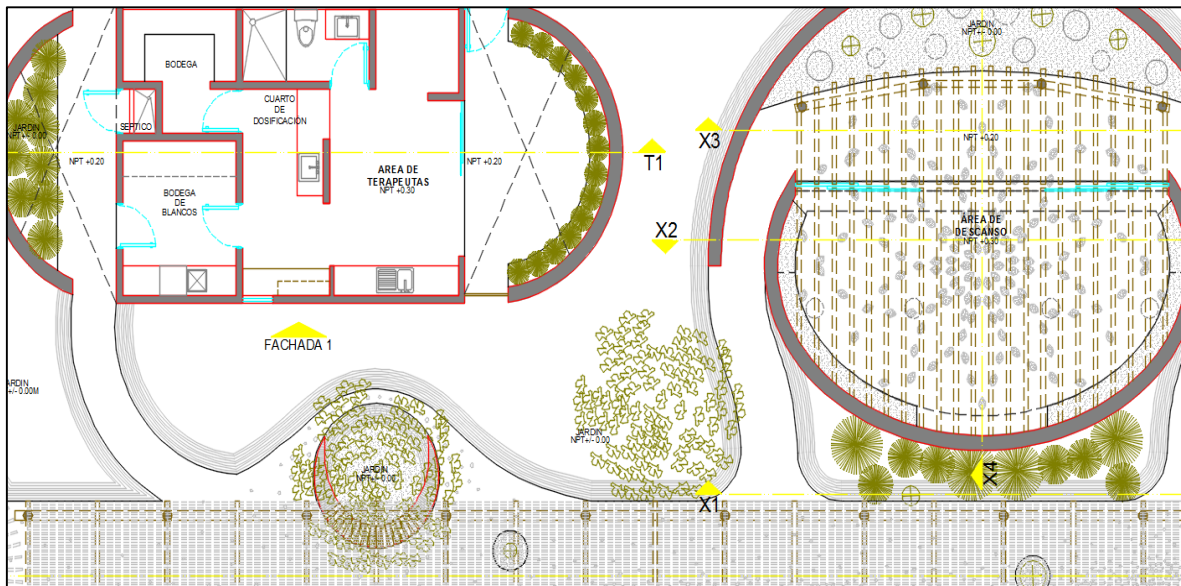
Planta arquitectónica del Área de descanso y Área de terapeutas del módulo de SPA.
